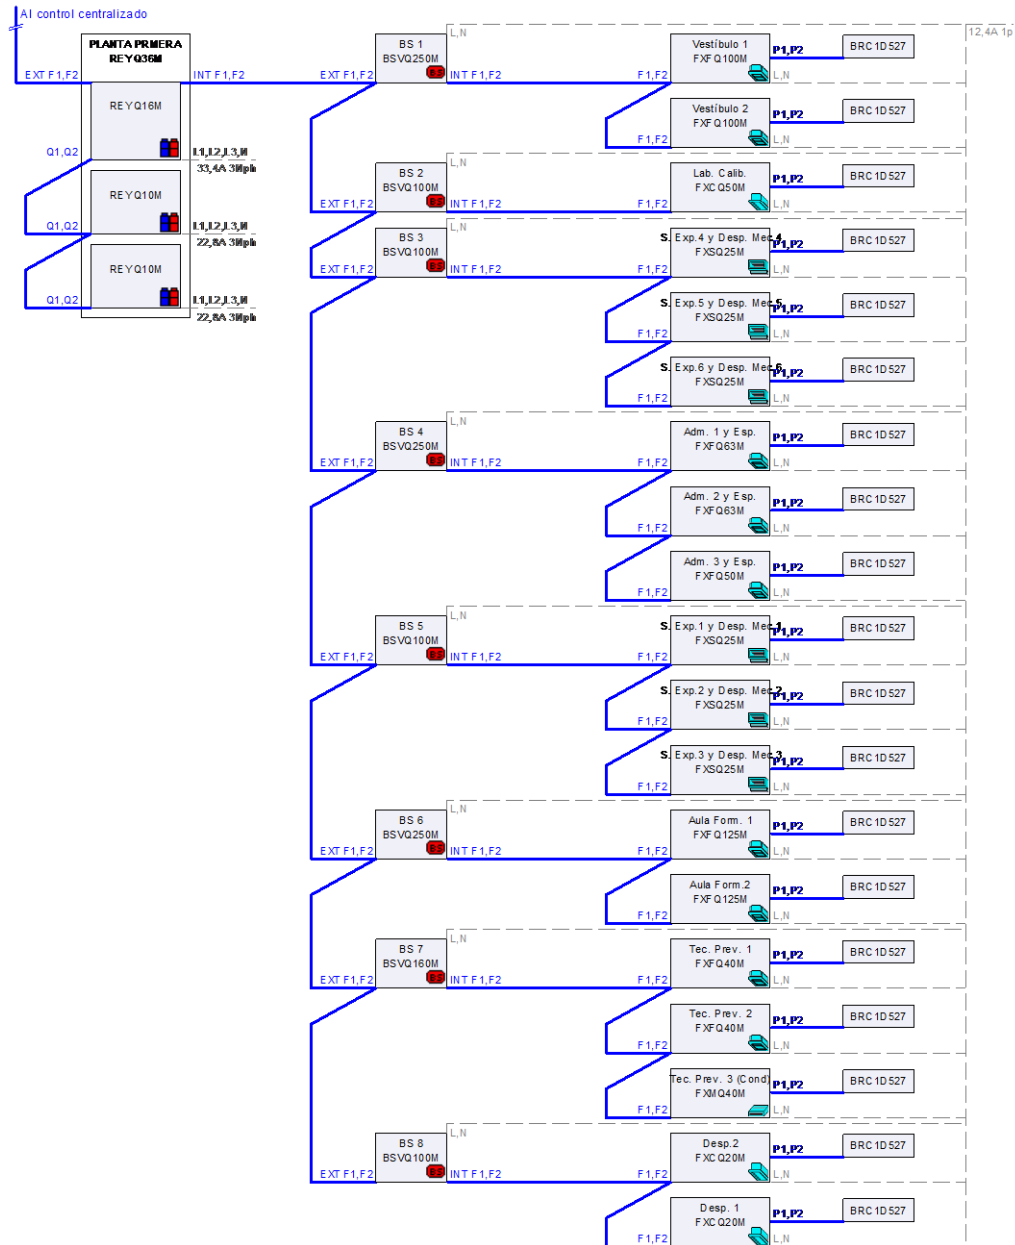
Esquema conexión eléctrica VRV. PLANTA PRIMERA
